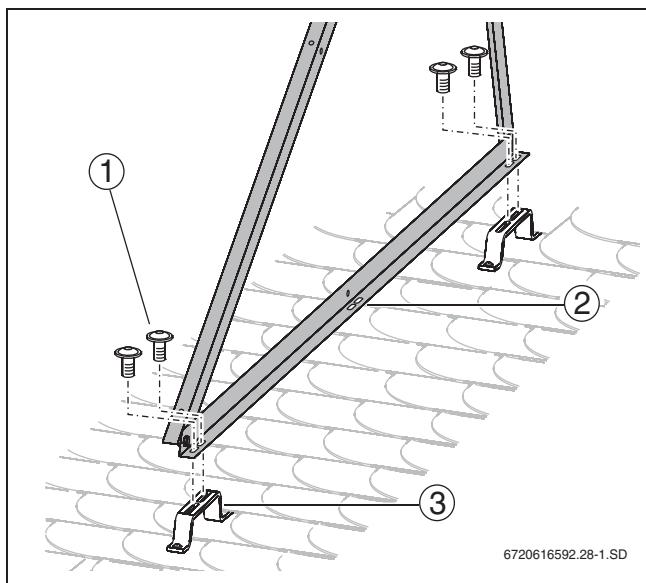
Крепление специальными кровельными крюками (здесь: на покрытие шифером/гонтом)
